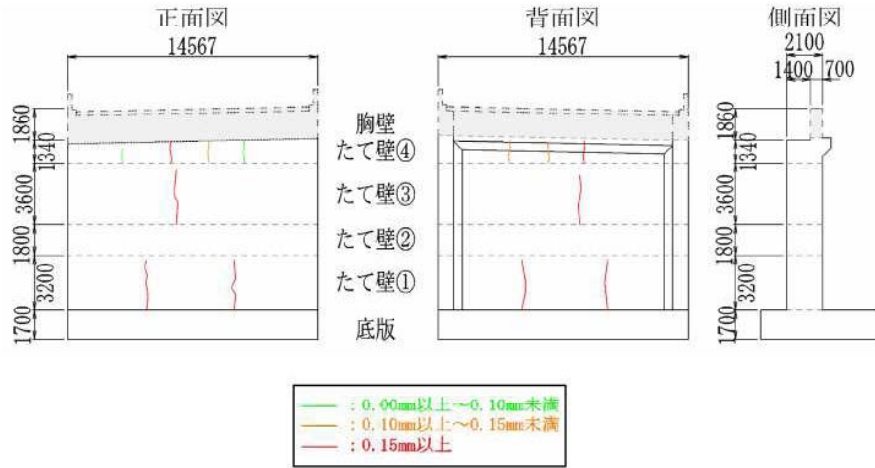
橋台たて壁のひび割れ状況(高炉B:無対策)
